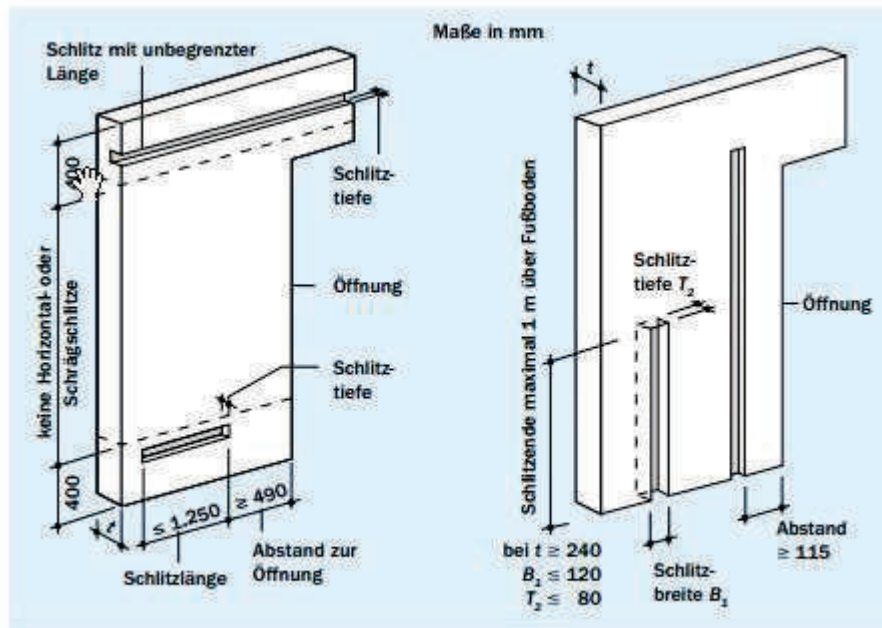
Nachträglich hergestellte horizontale und schräge Schlitz (links); nachträglich hergestellte vertikale Schlitz und Aussparungen (rechts)
